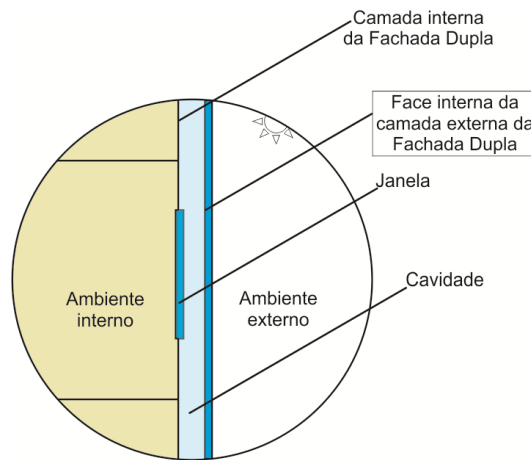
Detalhe da geometria com destaque para a face interna da camada externa da fachada.
